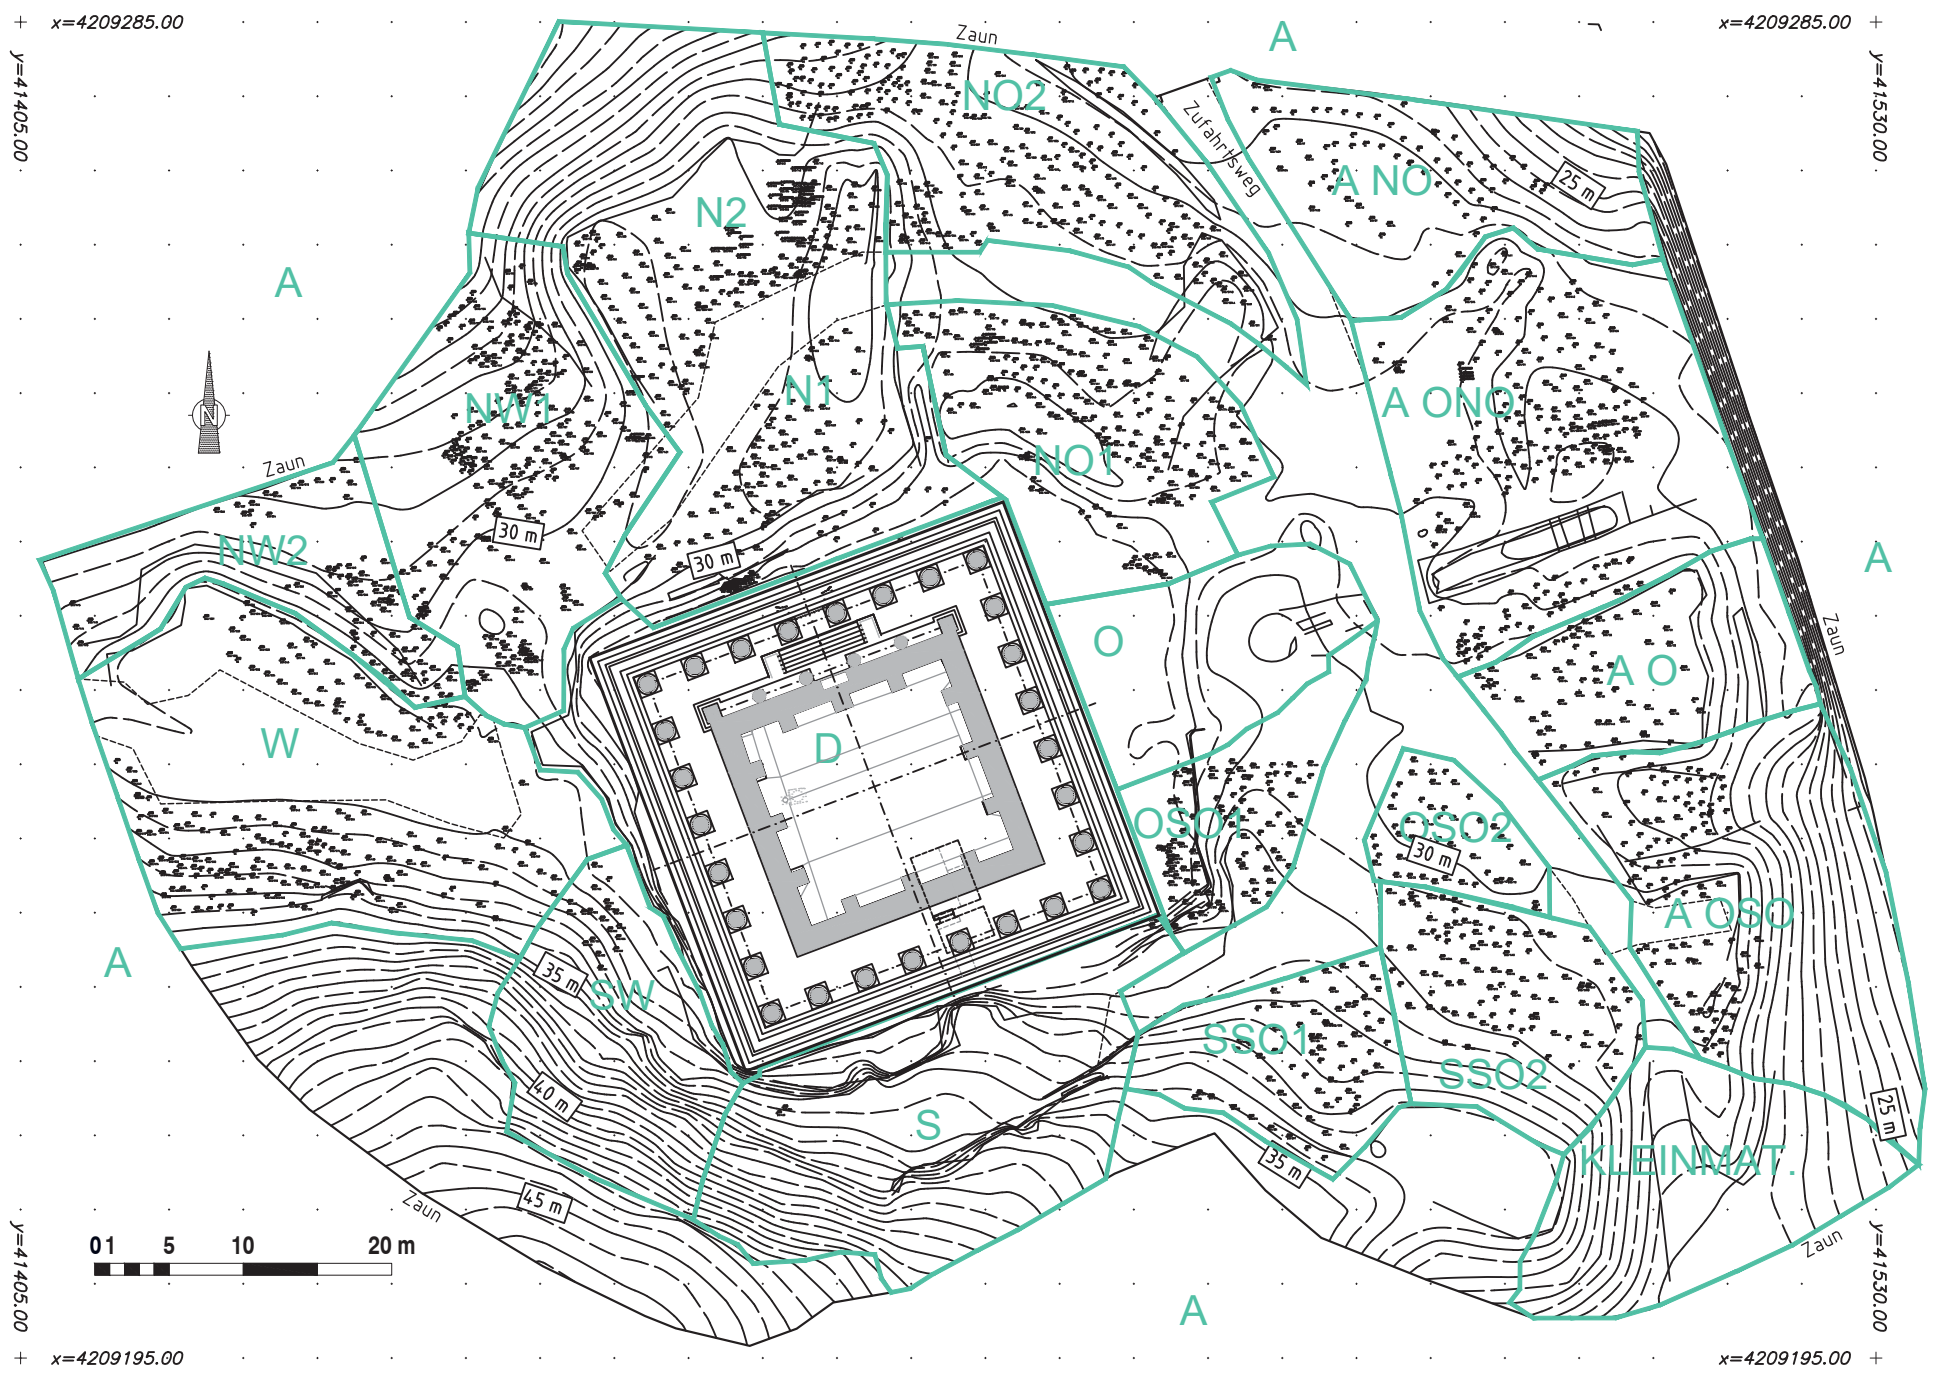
Lageplan mit Steinauslegeterrassen, M = 1 : 500.
